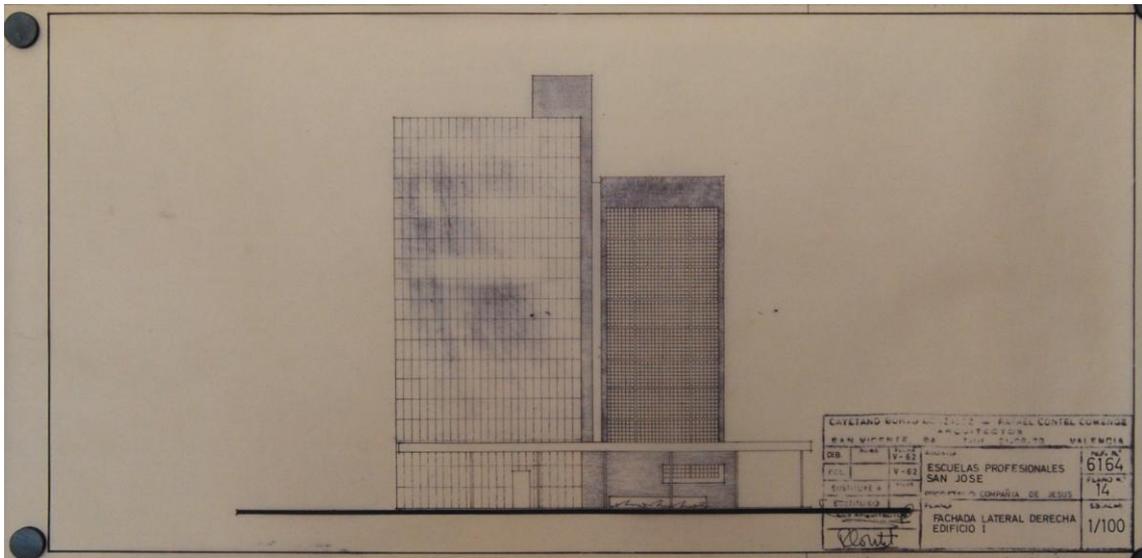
Alzado lateral. *Archivo Escuelas San José.
